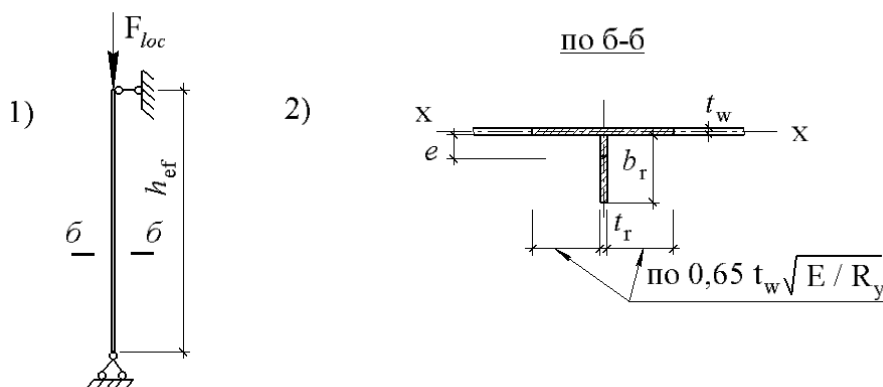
К расчету на устойчивость одностороннего поперечного ребра жесткости в стенке балки под локальной нагрузкой:
